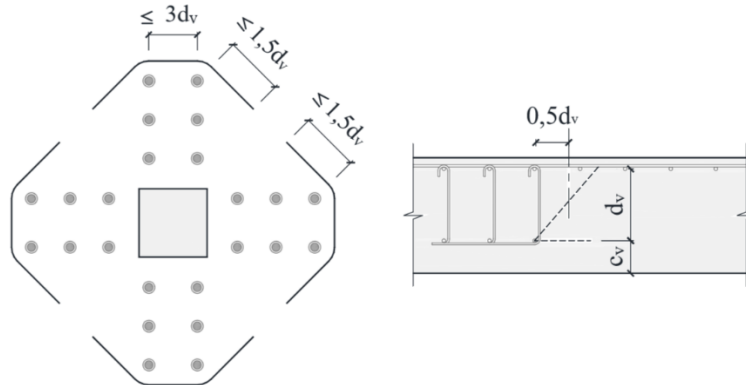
Perímetro de controle para lajes com armadura de cisalhamento (u_{out}).
